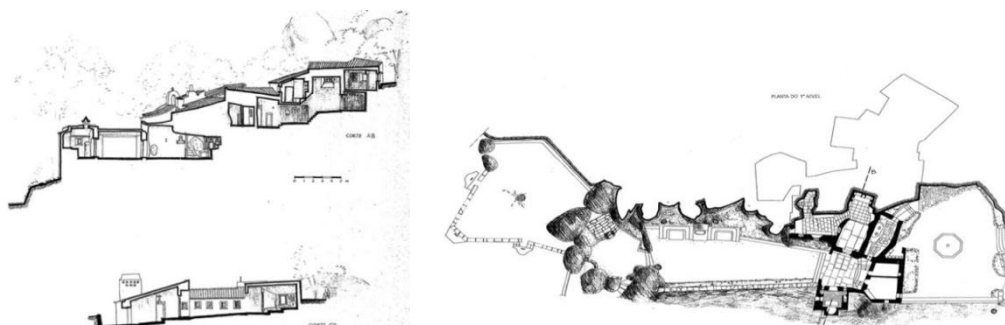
Convento dos Capuchos (corte e planta: seg. DGEMN/IHRU)
